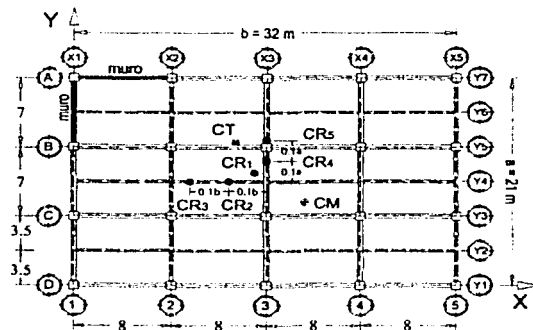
Planta de modelos excéntrico en rigideces. 1 muro en cada dirección.
